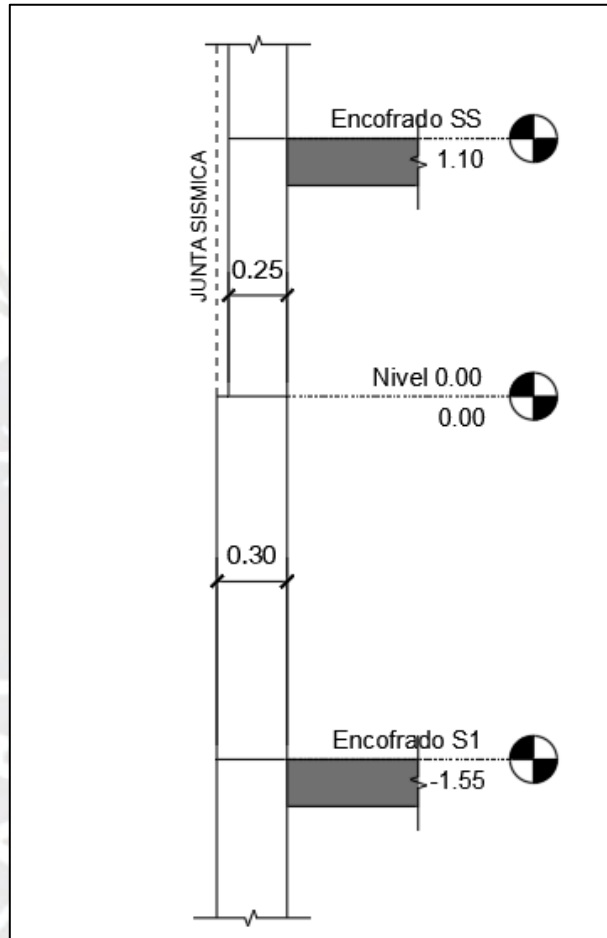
Elevación de Muro de Contención y Placa (Fuente: Propia)
